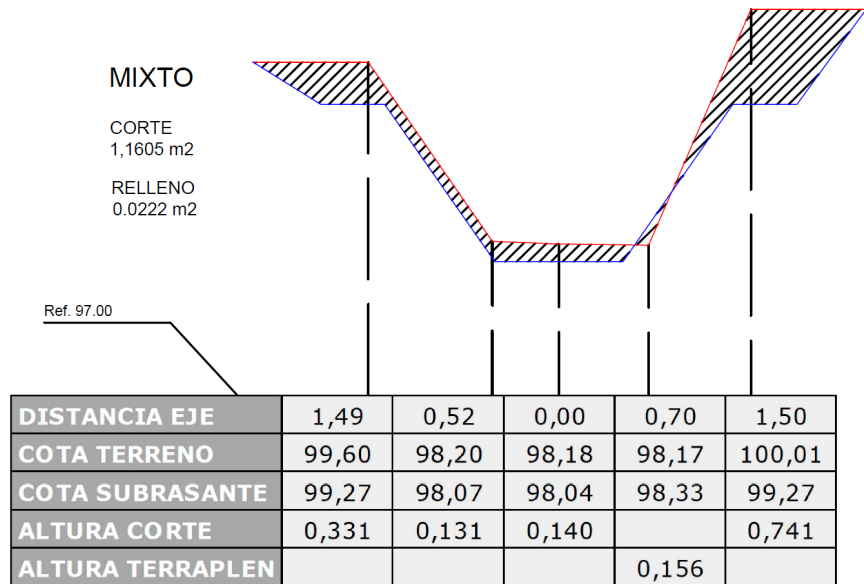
Perfil Transversal N°2 (Fuente Propia)
